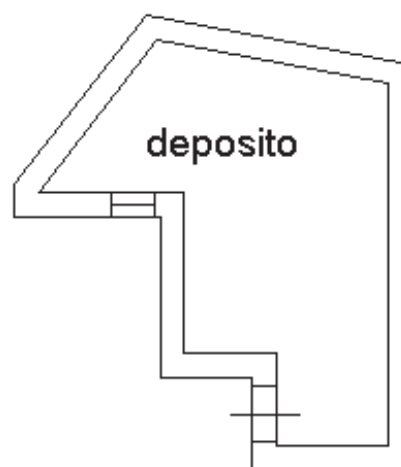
planimetria catastale del deposito al primo piano – sub 4
